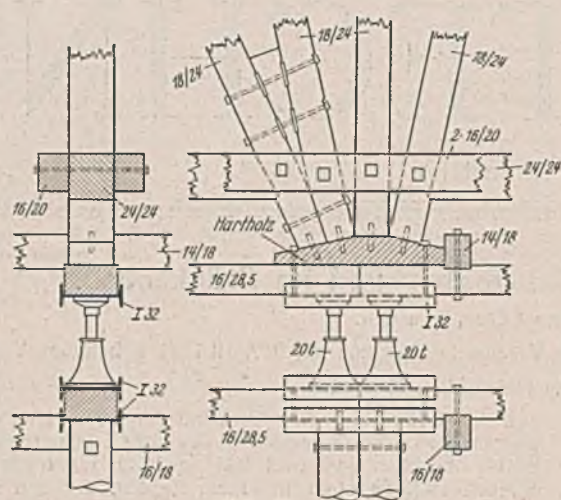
Aufbau des Obergerüsts auf dem Untergerüst.
